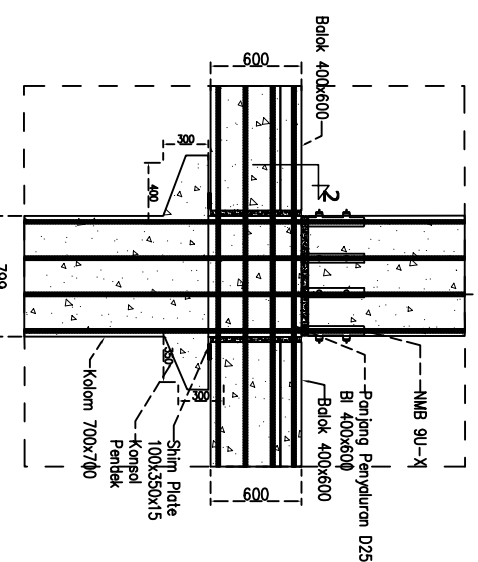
DETAIL SAMBUNGAN KOLOM K1-BALOK BI.1-BALOK BI.1 (C'-3)
